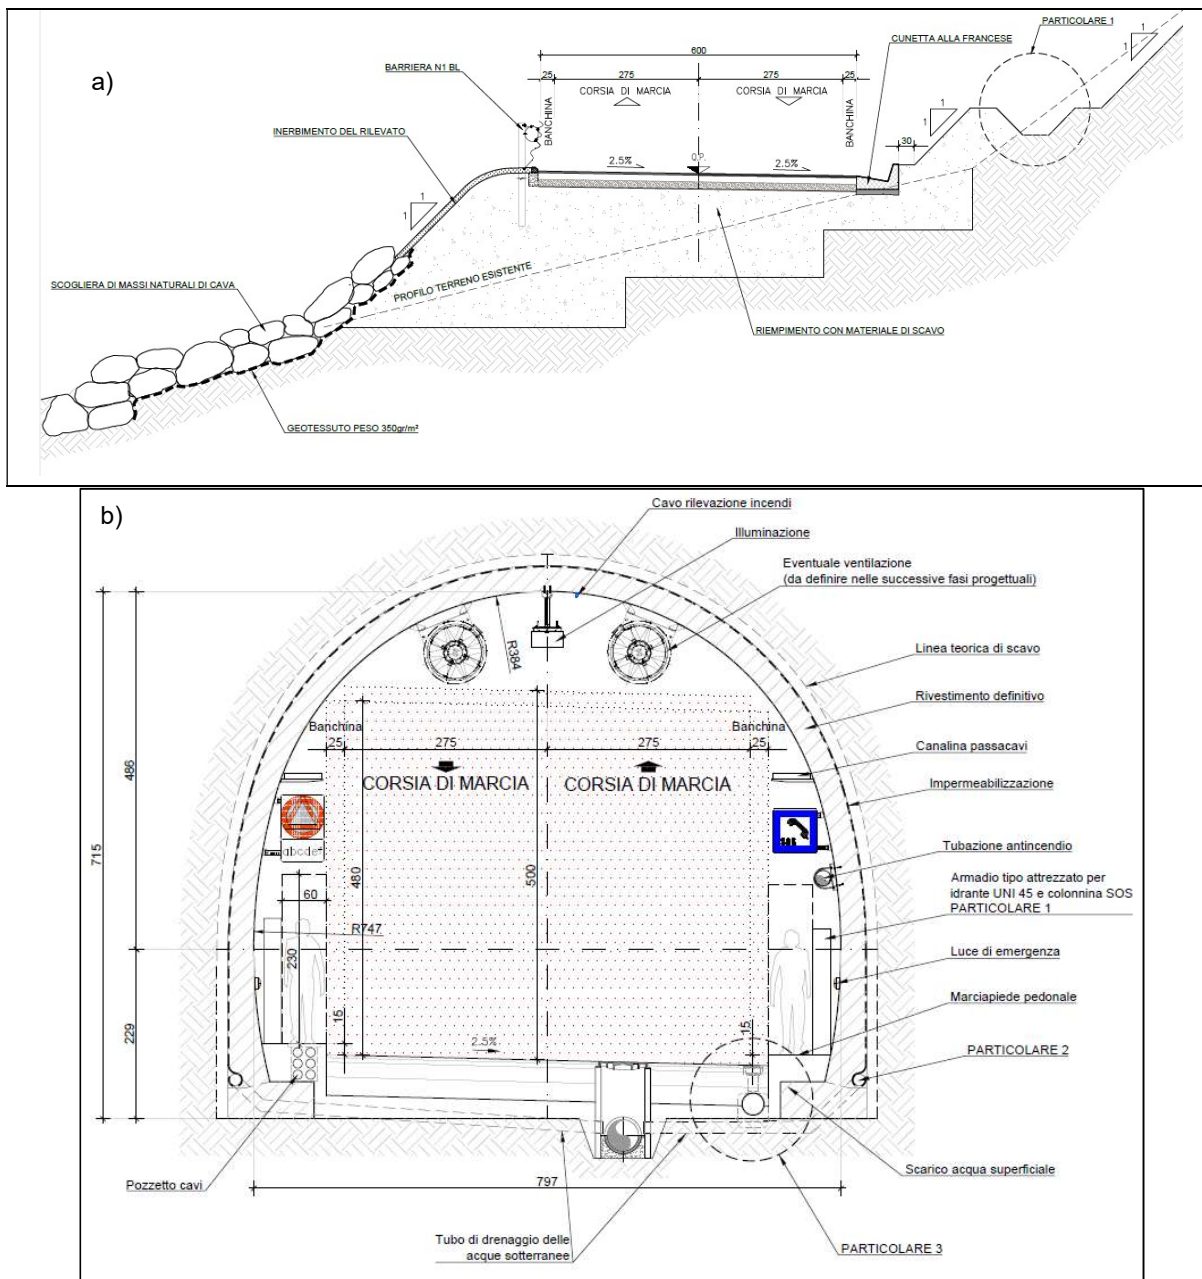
a) Sezione funzionale in rilevato; b) sezione funzionale in galleria.
